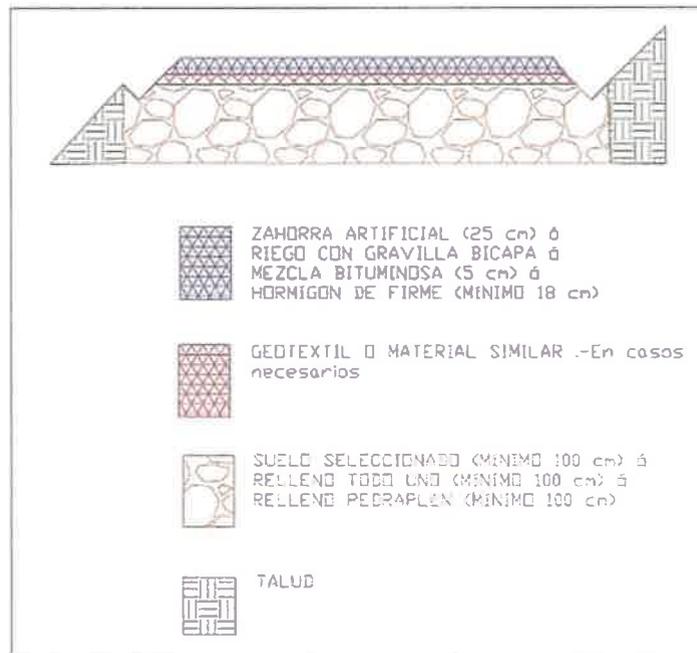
CORTE TRANSVERSAL DEL CAMINO.
